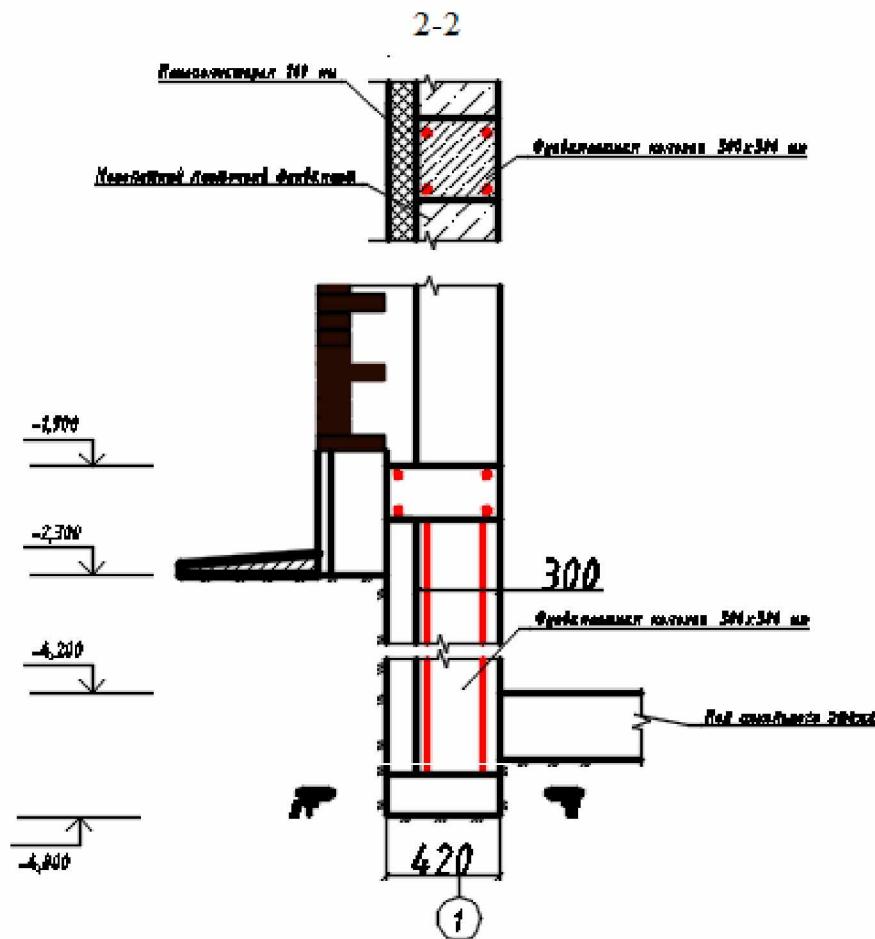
Конструктивная схема ленточного монолитного фундамента цокольного этажа в сечении 2-2
